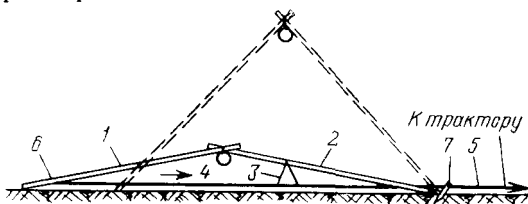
Схема подъема деревянной вышки с шкворневым соединением ног: 1, 2 — ноги вышки; 3 — козлы; 4 — блок; 5 — трос; 6 — место закрепления троса; 7 — упорный якорь
